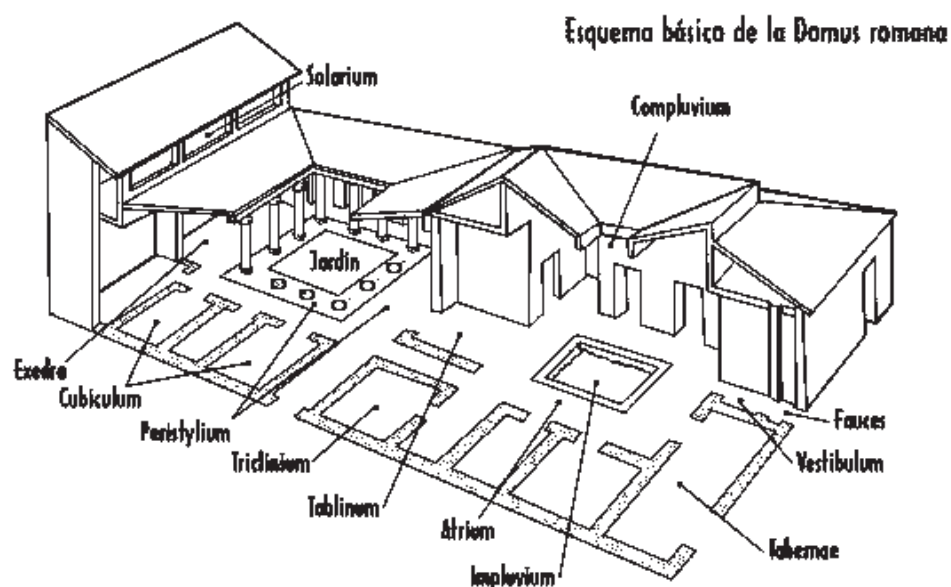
Planta arquitectónica de una vivienda residencial romana
